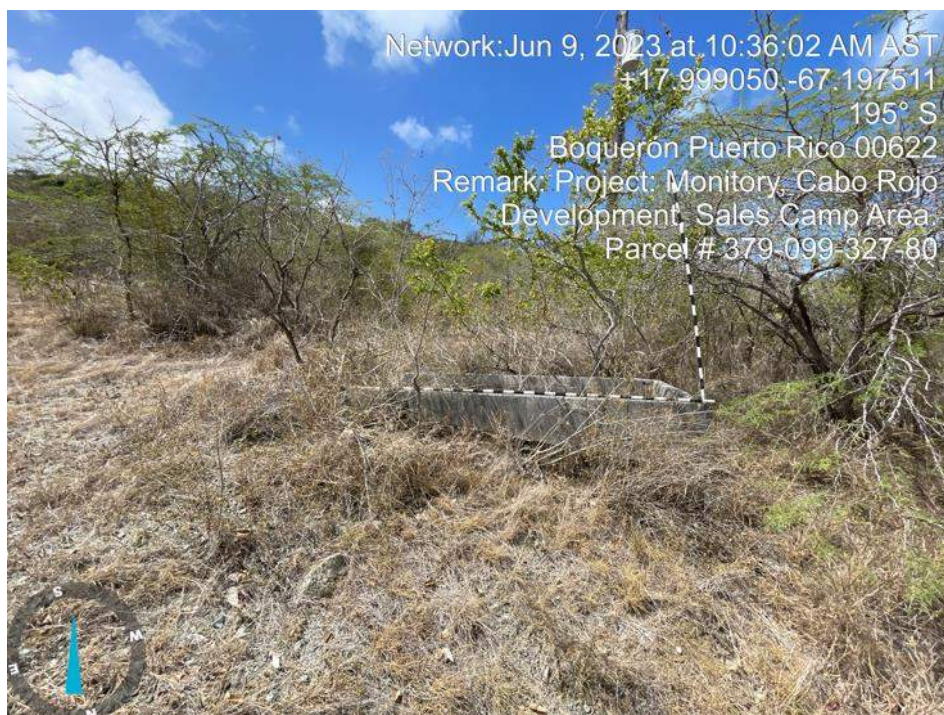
Elemento H-19, estructura de concreto siglo 20.
